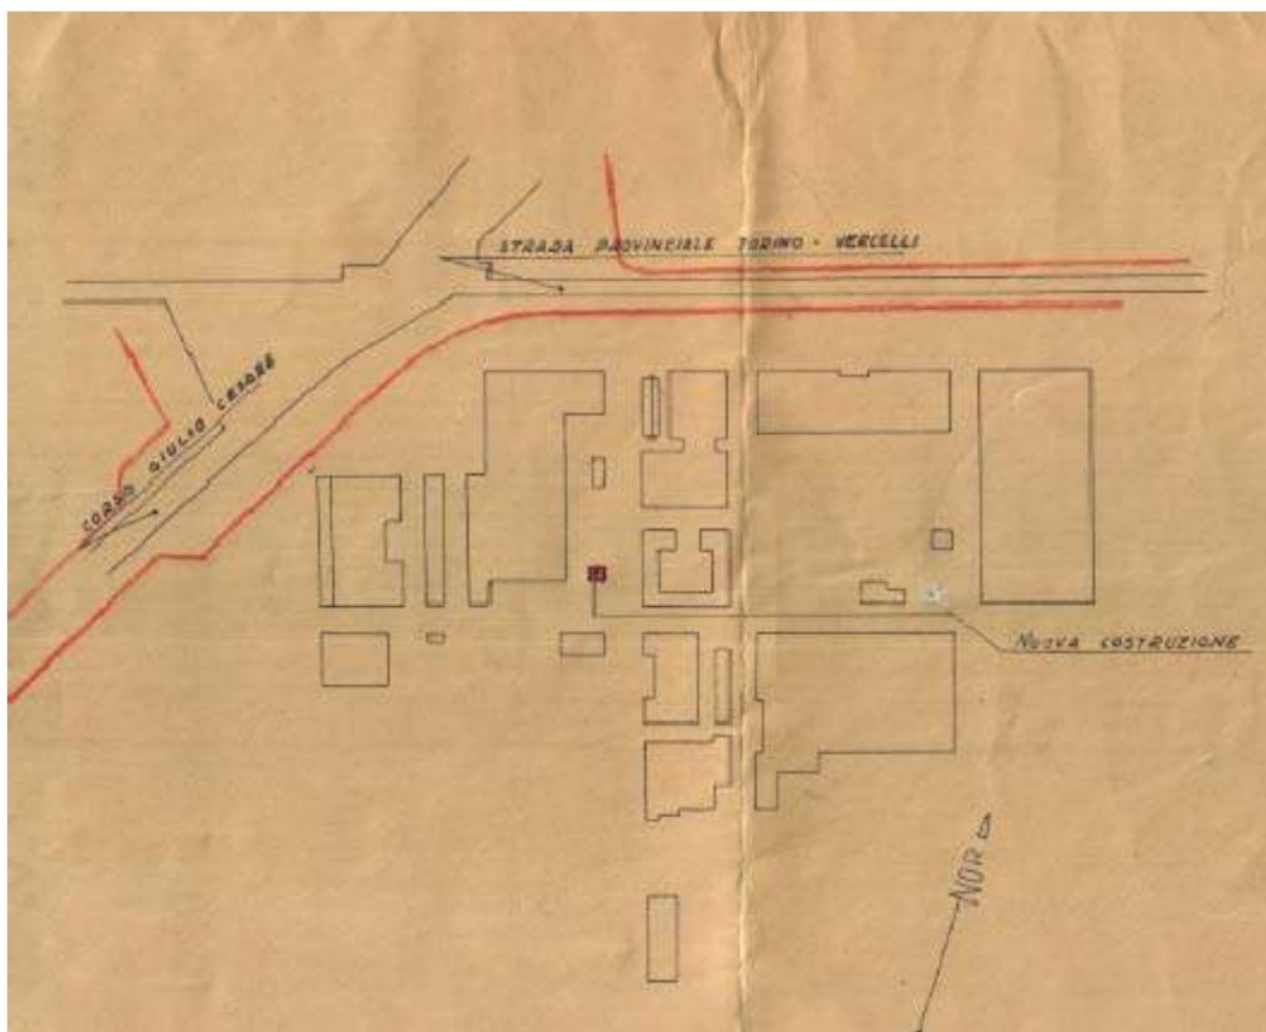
Planimetria catastale 1941 (Fonte dati Archivio Città di Torino)
